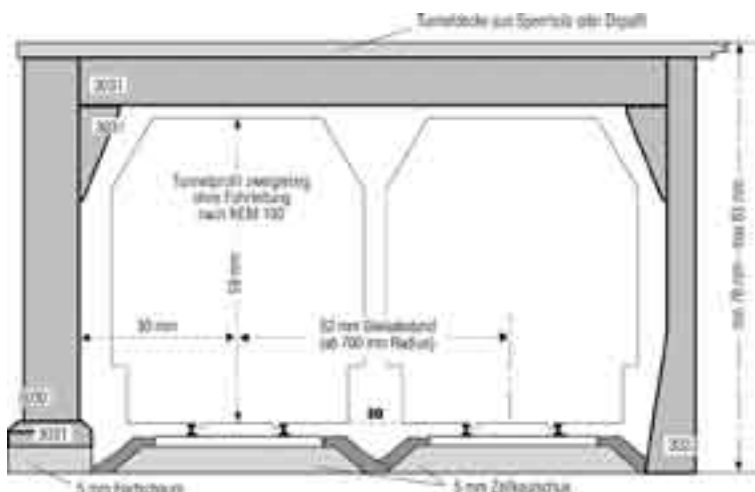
Zweigleisige Unterführung, gerade Strecke ohne Fahrleitung nach NEM 105. Bei Betrieb mit Fahrleitung Arkadenwand 3030 mit 3031 aufstocken.
